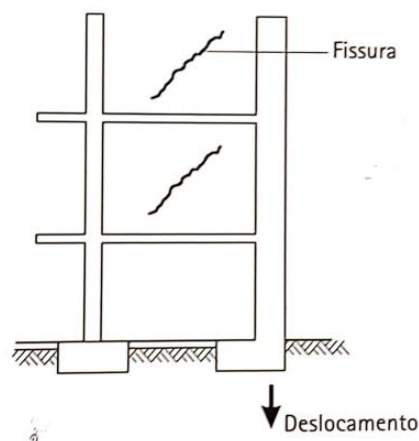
Exemplo de recalque de fundação de pilar de canto (Fonte: Milititsky; Consolini; Schnaid, 2018).
